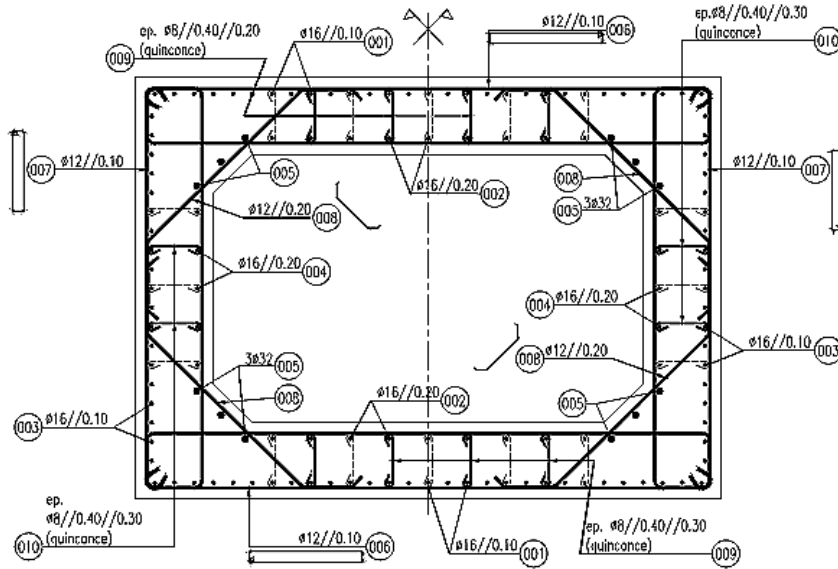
Le ferrailage longitudinal et transversal à la tête et au pied de fût des piles courtes
